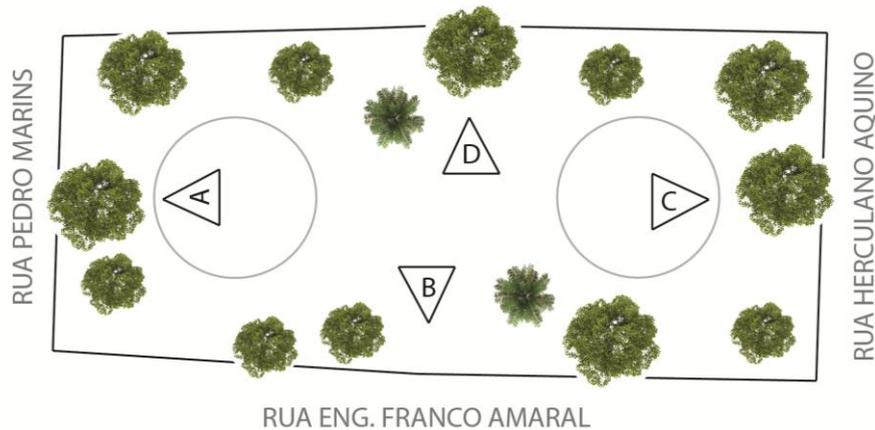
Planta da Praça dos Trovadores com indicação das visadas do entorno.
